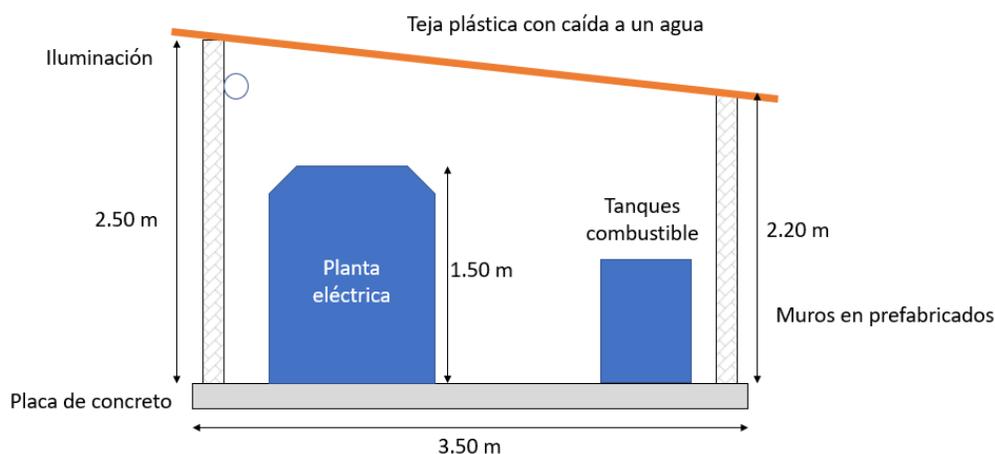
Plano en perfil de la estructura para el generador eléctrico
